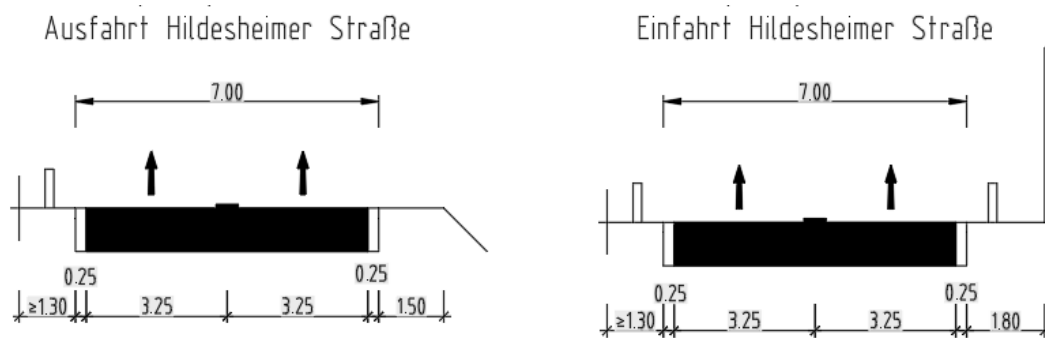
Rampenquerschnitt RRQ 2 Hildesheimer Straße
